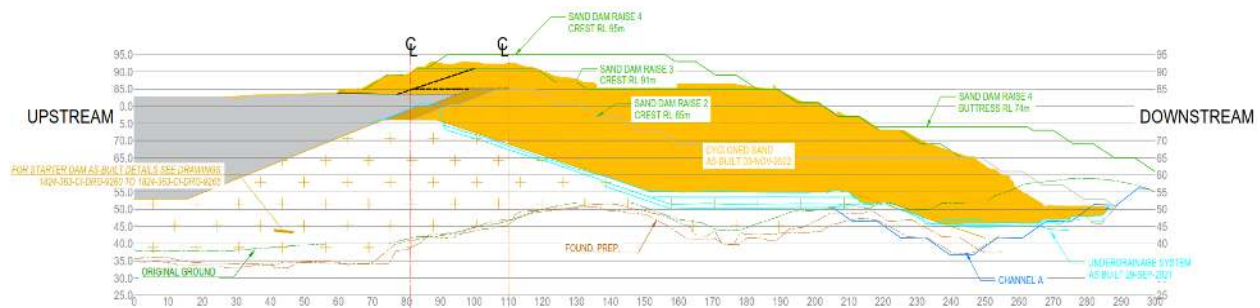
2: Sección de construcción de la presa norte en 0+850 – 03/noviembre/2022
